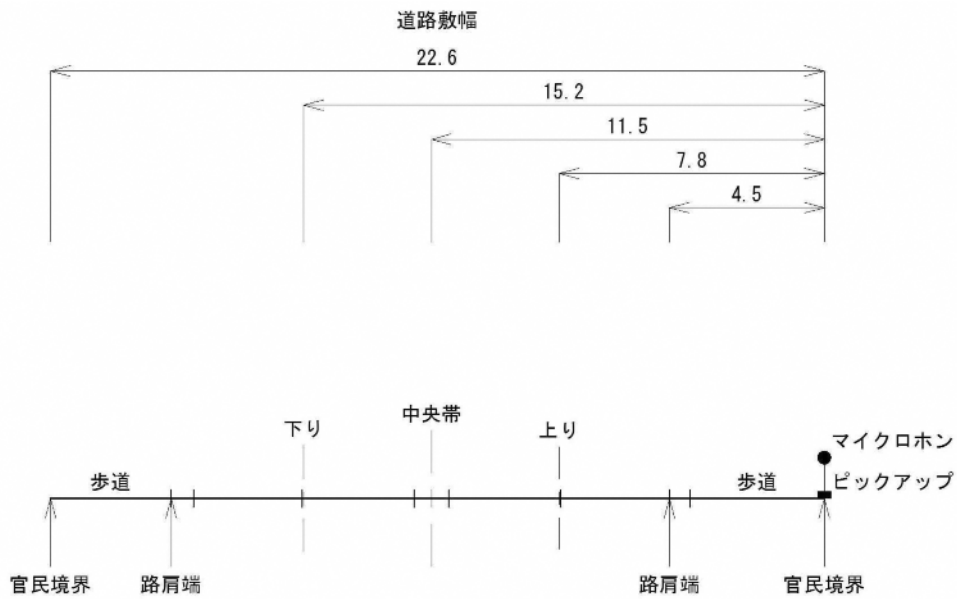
(2) 調査地点道路断面図(単位 : m)
